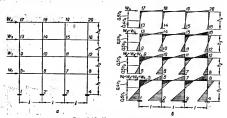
Многоэтажная рама: а — заданная схема; б — расчлененная схема.
